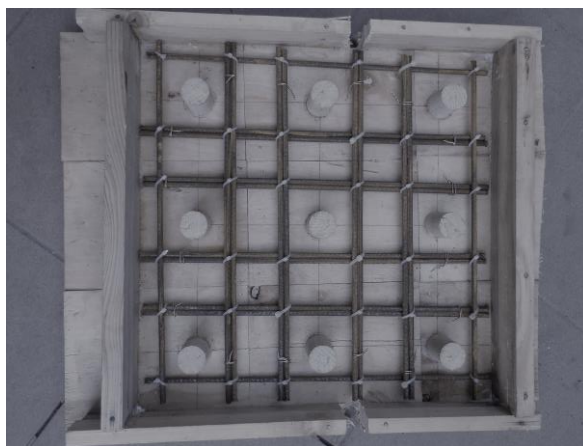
Опалубка і схема розташування арматури ростверку розмірами 410x410 мм
